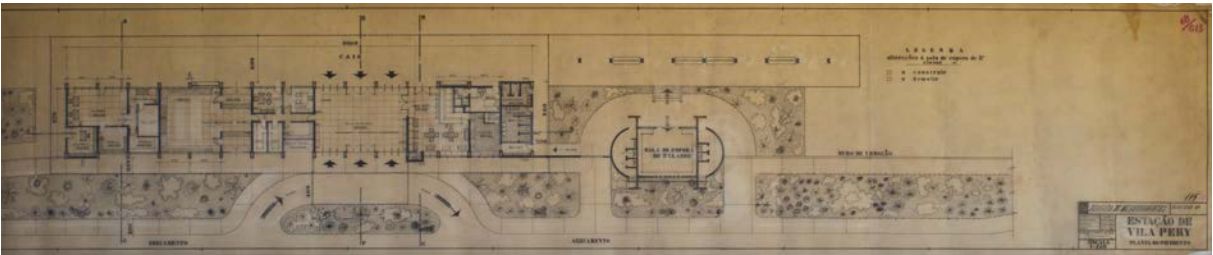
Estação de Vila Pery. Planta do Pavimento, Brigada de Melhoramentos dos C.F.B., 1961
